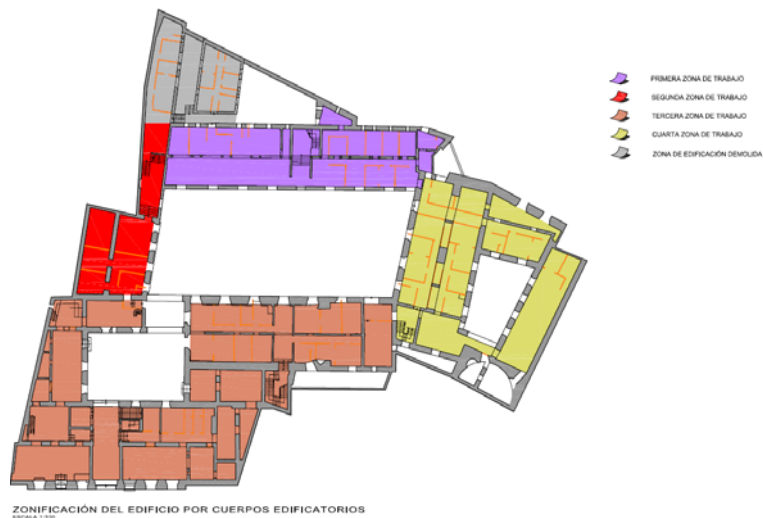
Planta de forjado desarrollado en el estudio de patologías
